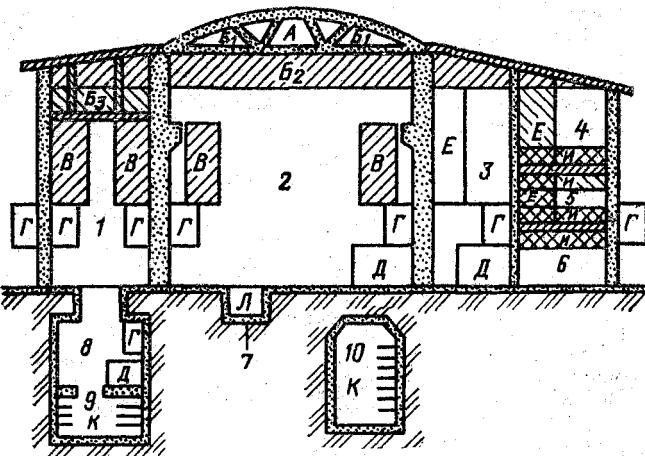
Типовые электротехнические зоны для размещения электротехнического оборудования и сетей:
